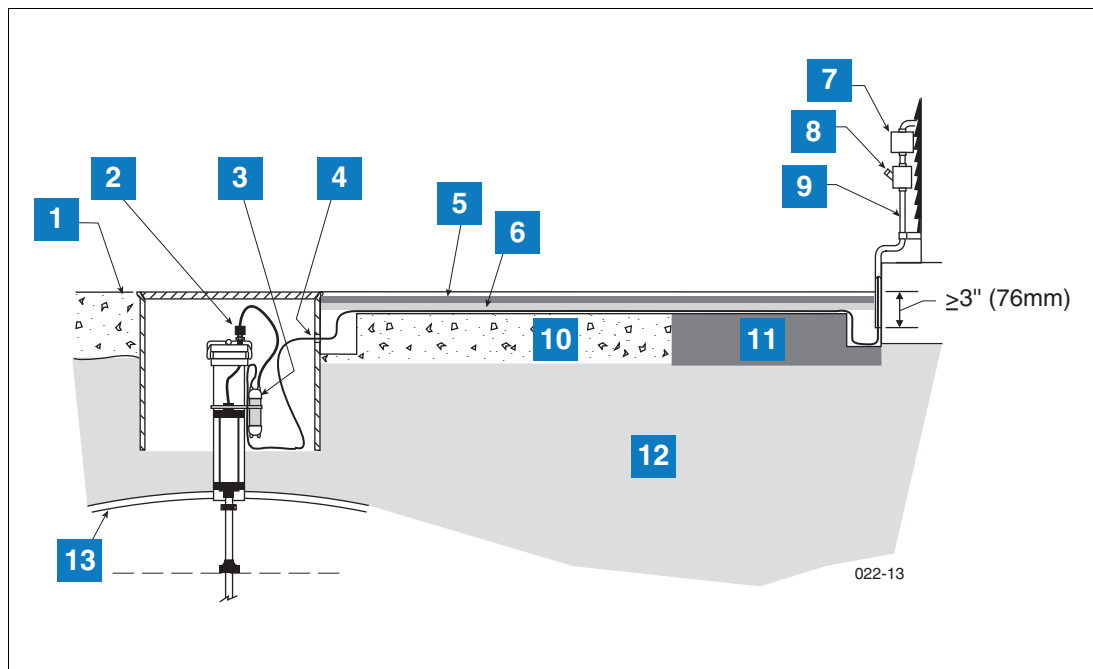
Exemplo da Instalação do Cabeamento de Sonda Via Cabo Enterrado Direto
